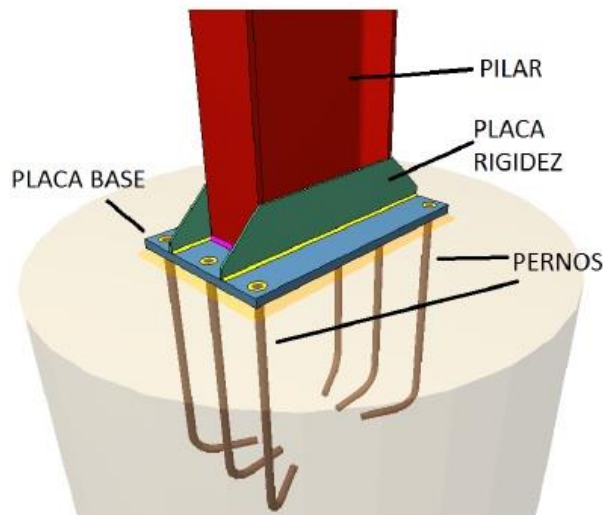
Placa anclaje 3D. (Fuente: Cype 3D)
